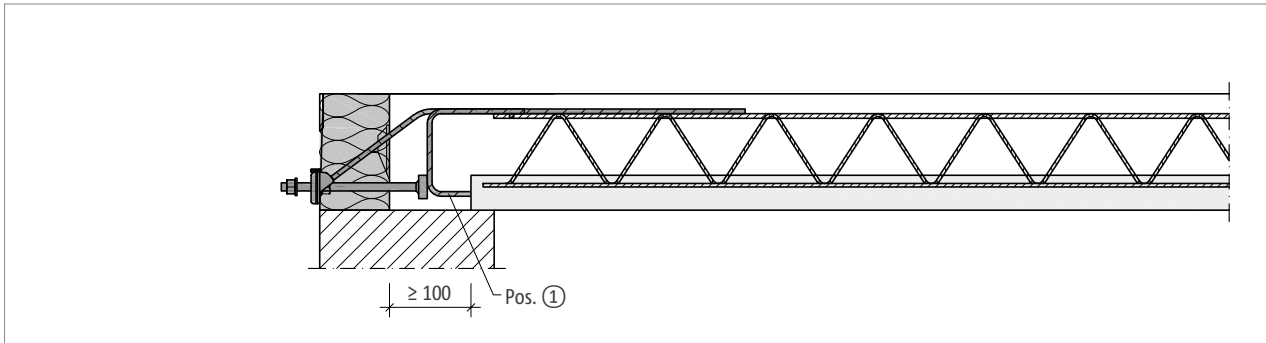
Schöck Isokorb® XT Typ SQP: Bauseitige Bewehrung bei Halfertigteilbauweise, Schnitt
